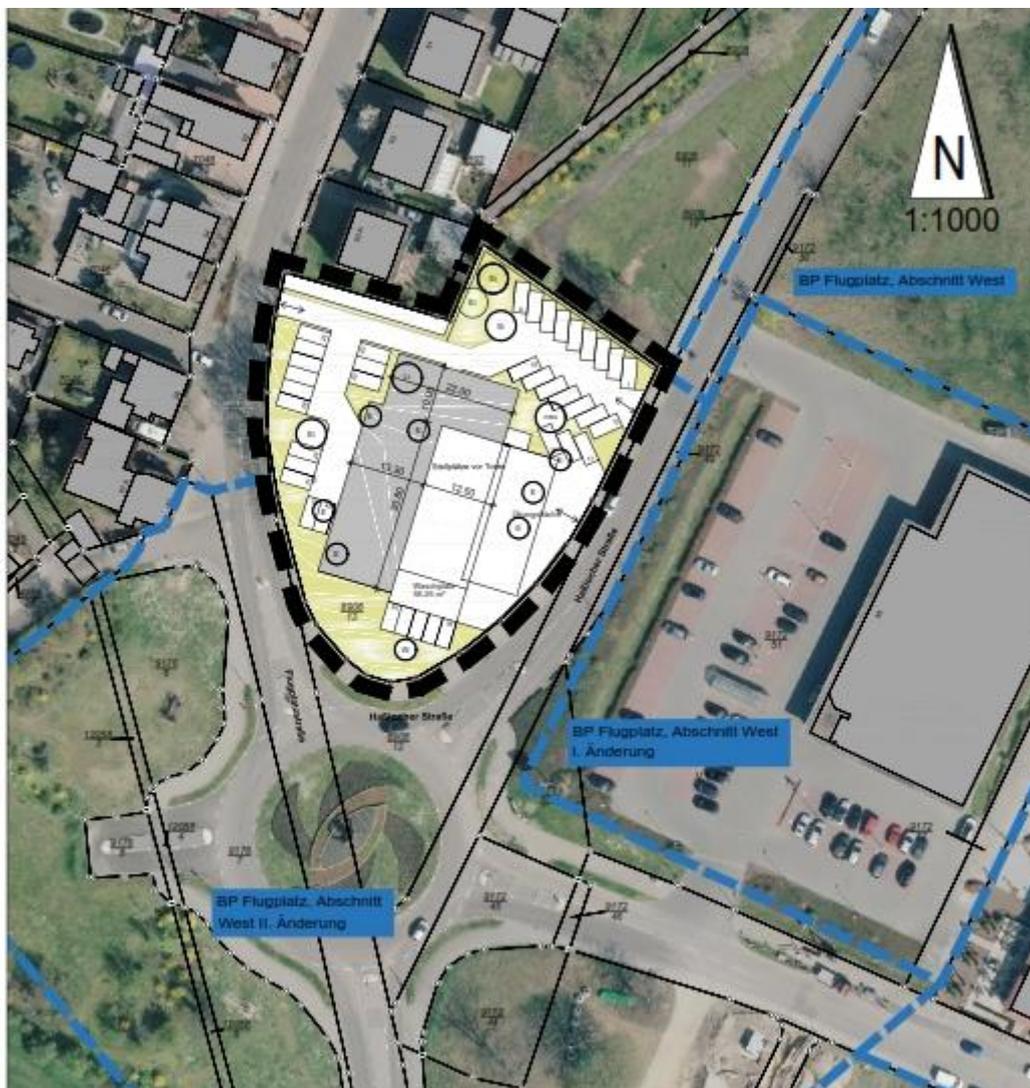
Auszug Planzeichnung Bebauungsplan
